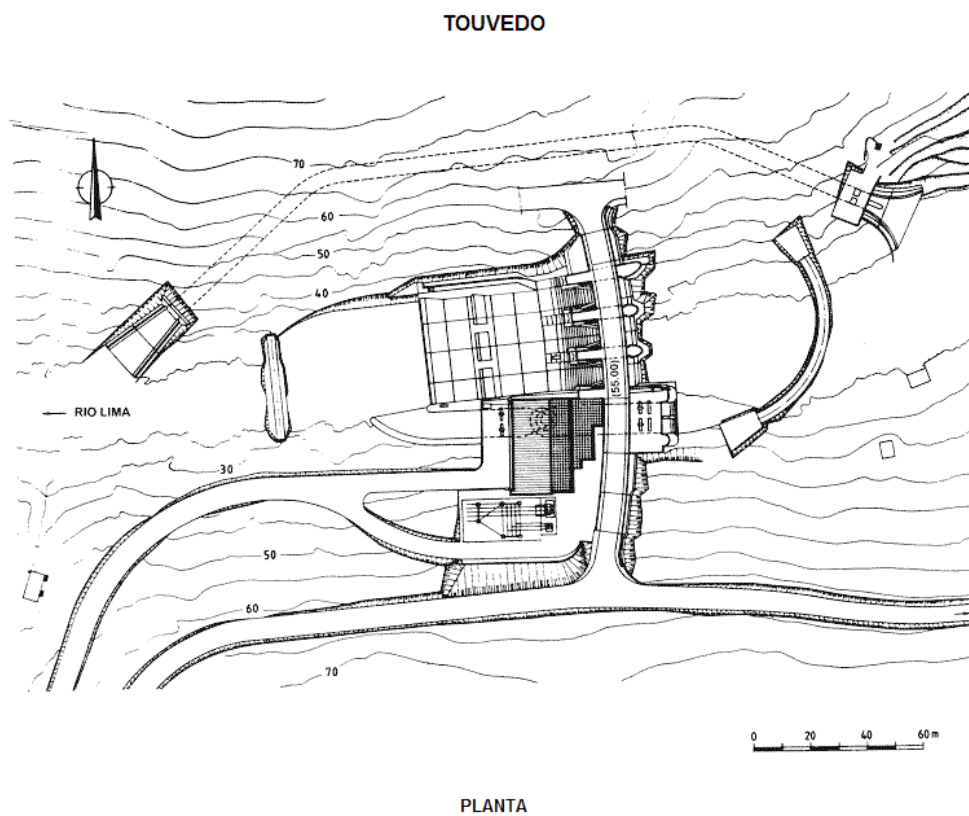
Barragem de Touvedo – Planta [4]
